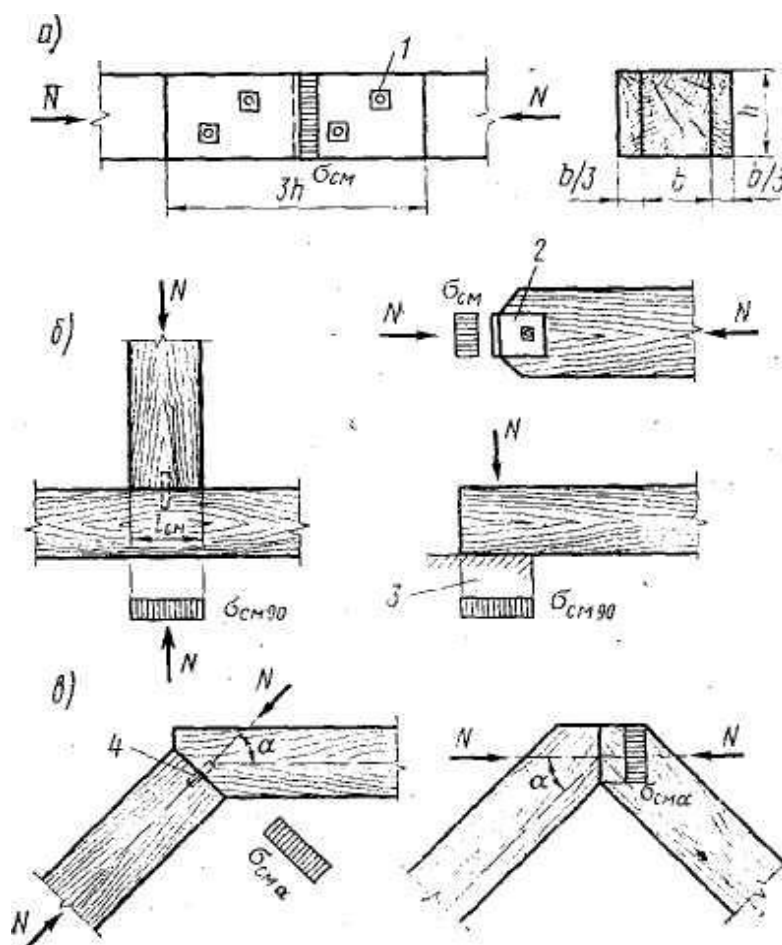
Лобовые упоры: а - продольные; б - поперечные; в - наклонные; 1 – стяжной болт; 2 – узловое крепление; 3 – опора; 4 – штырь
